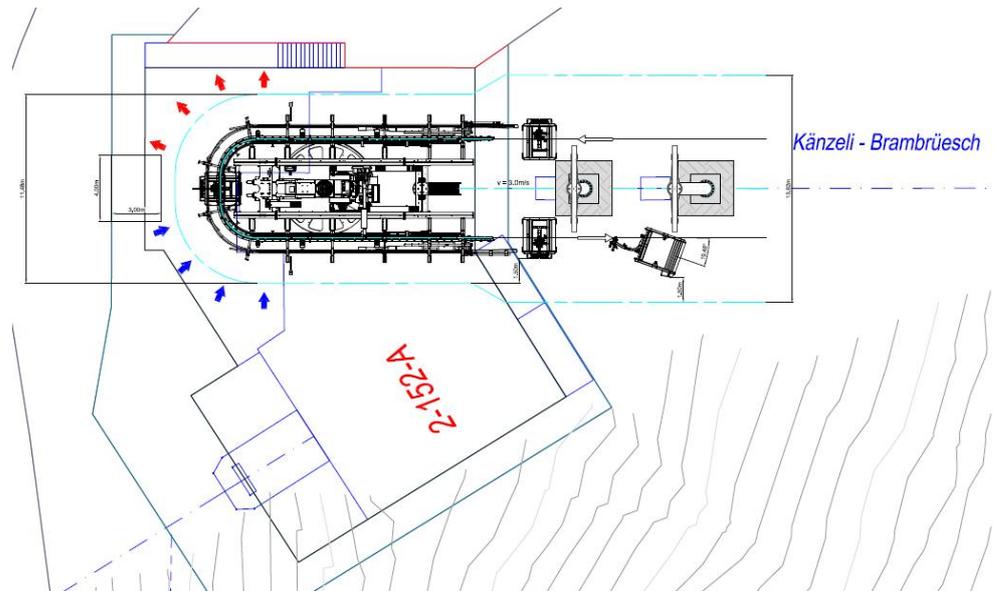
Möglicher Grundriss Talstation Känzeli
